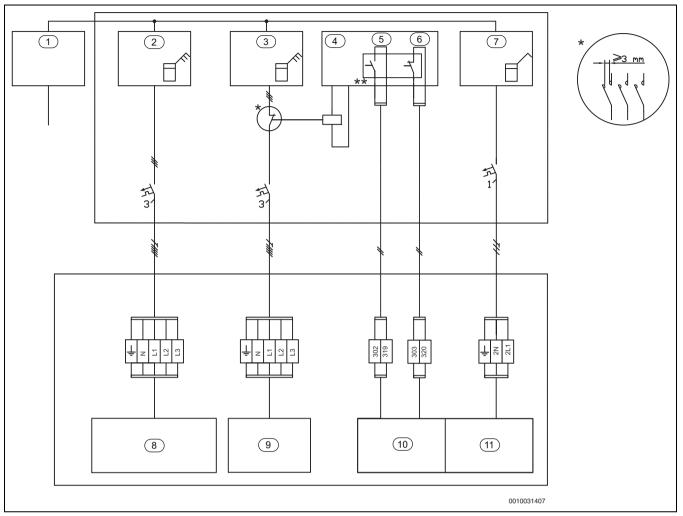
EVU тип 3 с остановом, компрессор/электронагревательный элемент
